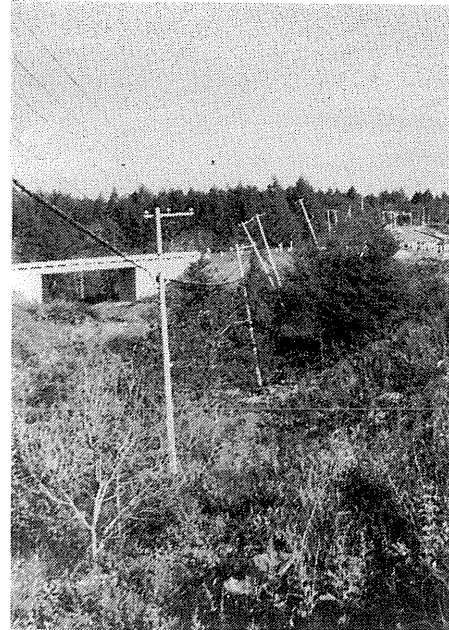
道路盛土崩壊による電柱の傾斜
